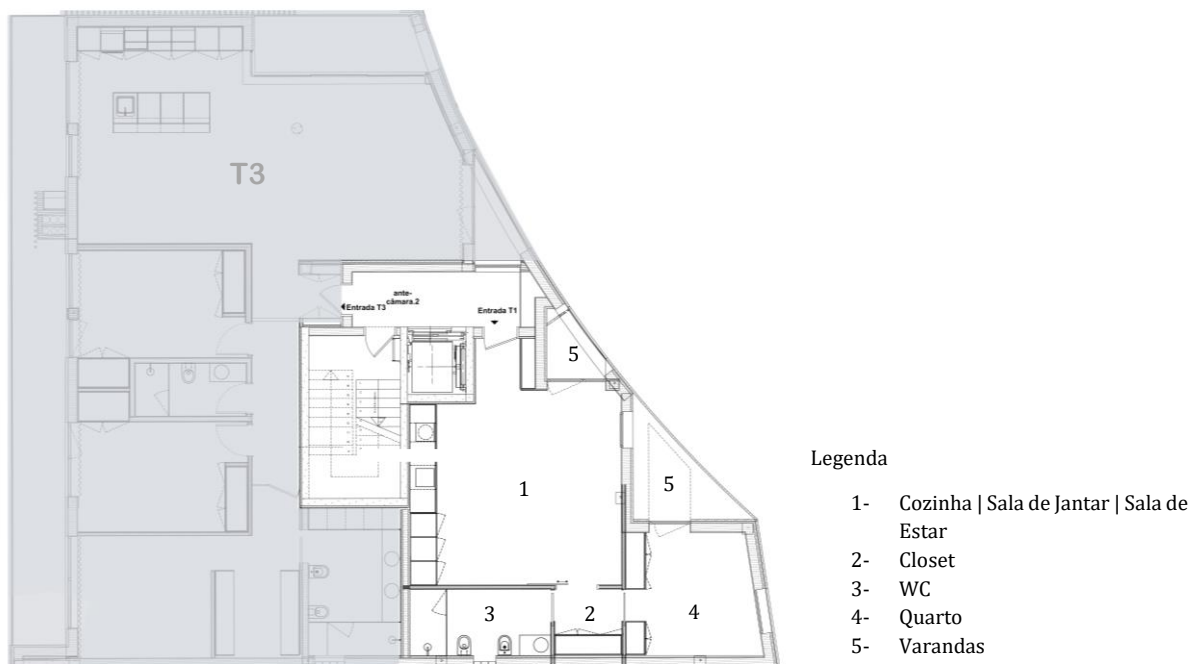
Planta base do apartamento T1. Fonte: 2L'atelier
